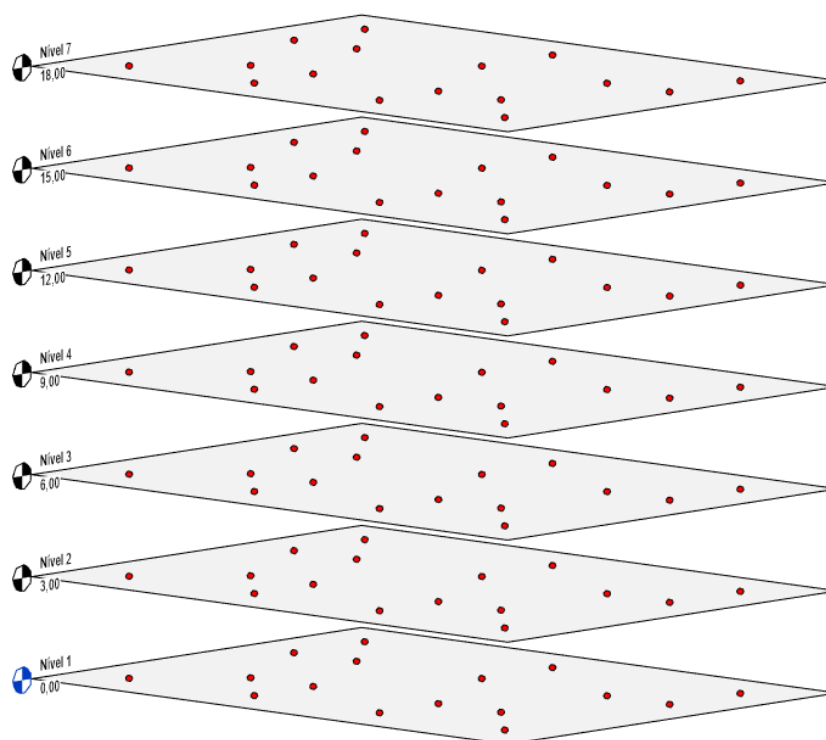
Vista em planta dos pontos de interseção entre linhas de localização de paredes
